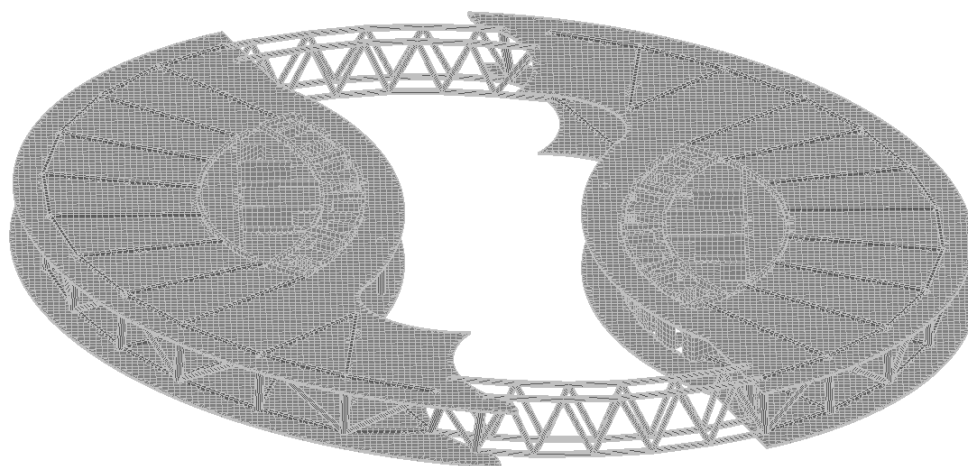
Загальний вигляд несучих конструкцій
